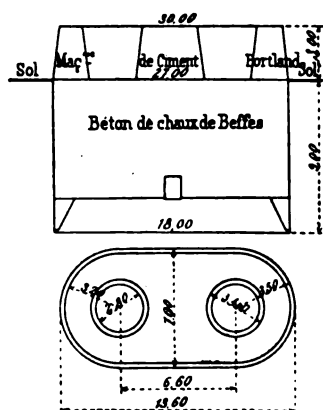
Caisson de fondation pour machines de 2 000 chevaux.
